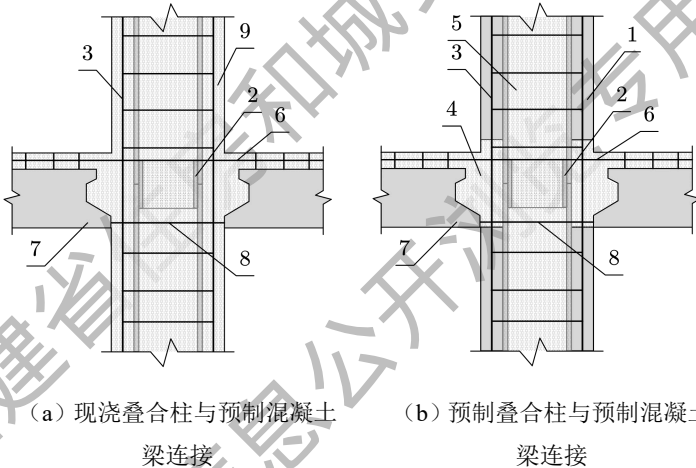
叠合柱与预制钢筋混凝土梁短钢槽螺栓连接
